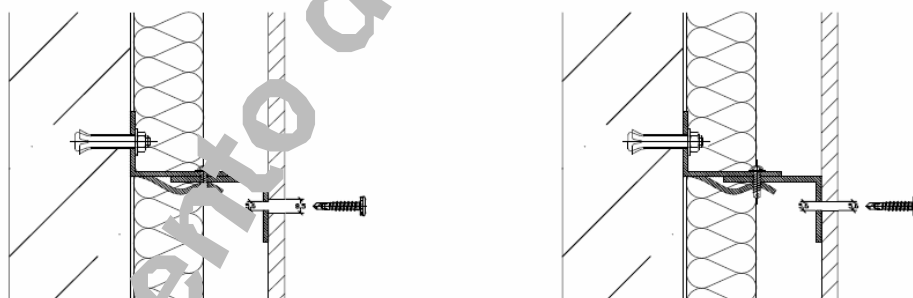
SUBESTRUCTURA METÁLICA
